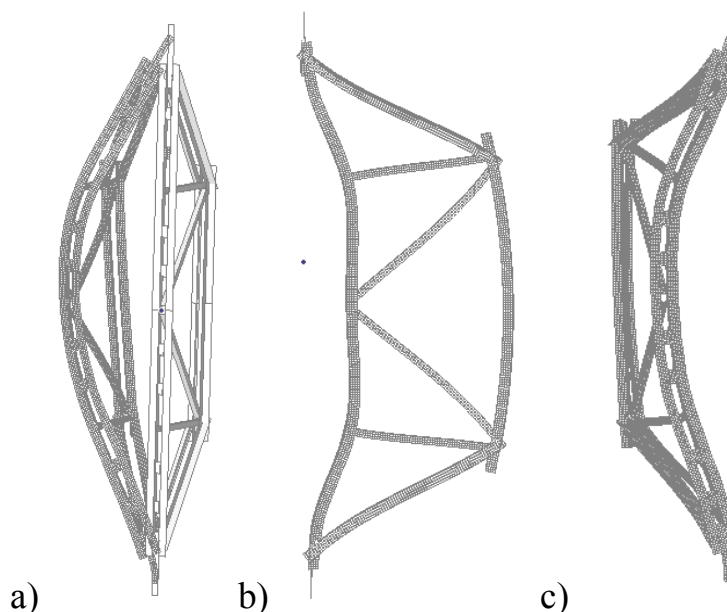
Model powłokowy konstrukcji: a) widok fragmentu konstrukcji, b) szczegół mocowania w podporze, c) szczegół połączenia pręta złożonego z krzyżulcami
